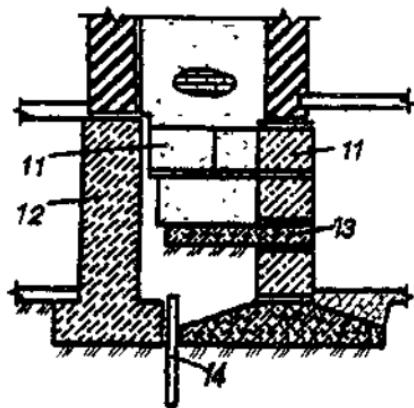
Примеры конструктивного решения по устройству дополнительных фундаментов при реконструкции зданий:
